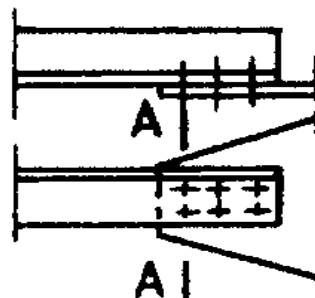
Расположение проверяемого на выносливость расчетного сечения А-А по основному металлу в сечении брутто по первому ряду высокопрочных болтов в прикреплении фасонки к нестыкуемым в данном узле поясам сплошных балок и элементам решетчатых форм
